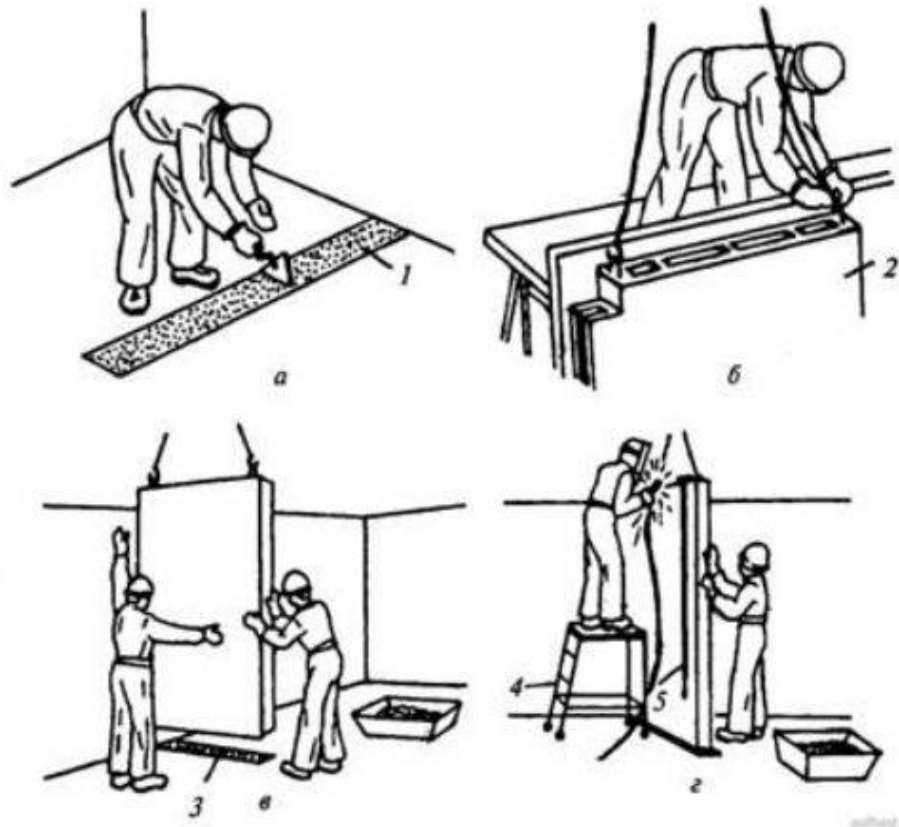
Установка вентиляційних блоків із залізобетону.
